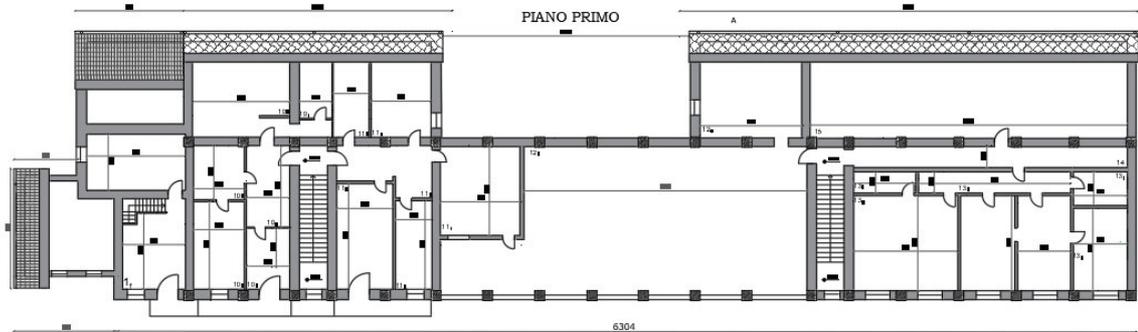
Pianta primo piano, stato di fatto fuori scala.
